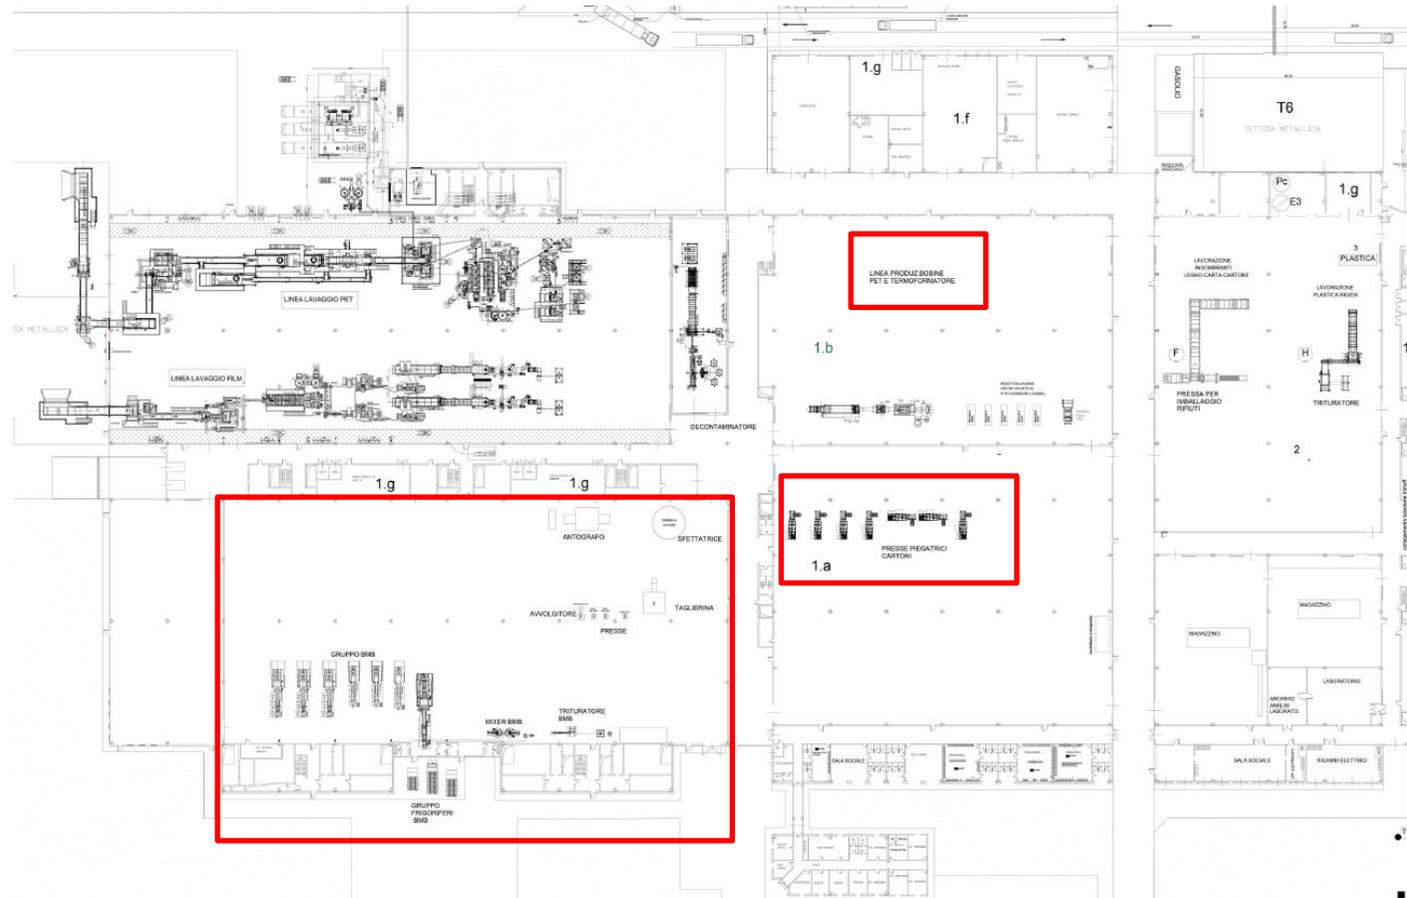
Stralcio layout stato di fatti. In evidenza le aree da spostare nel nuovo capannone
